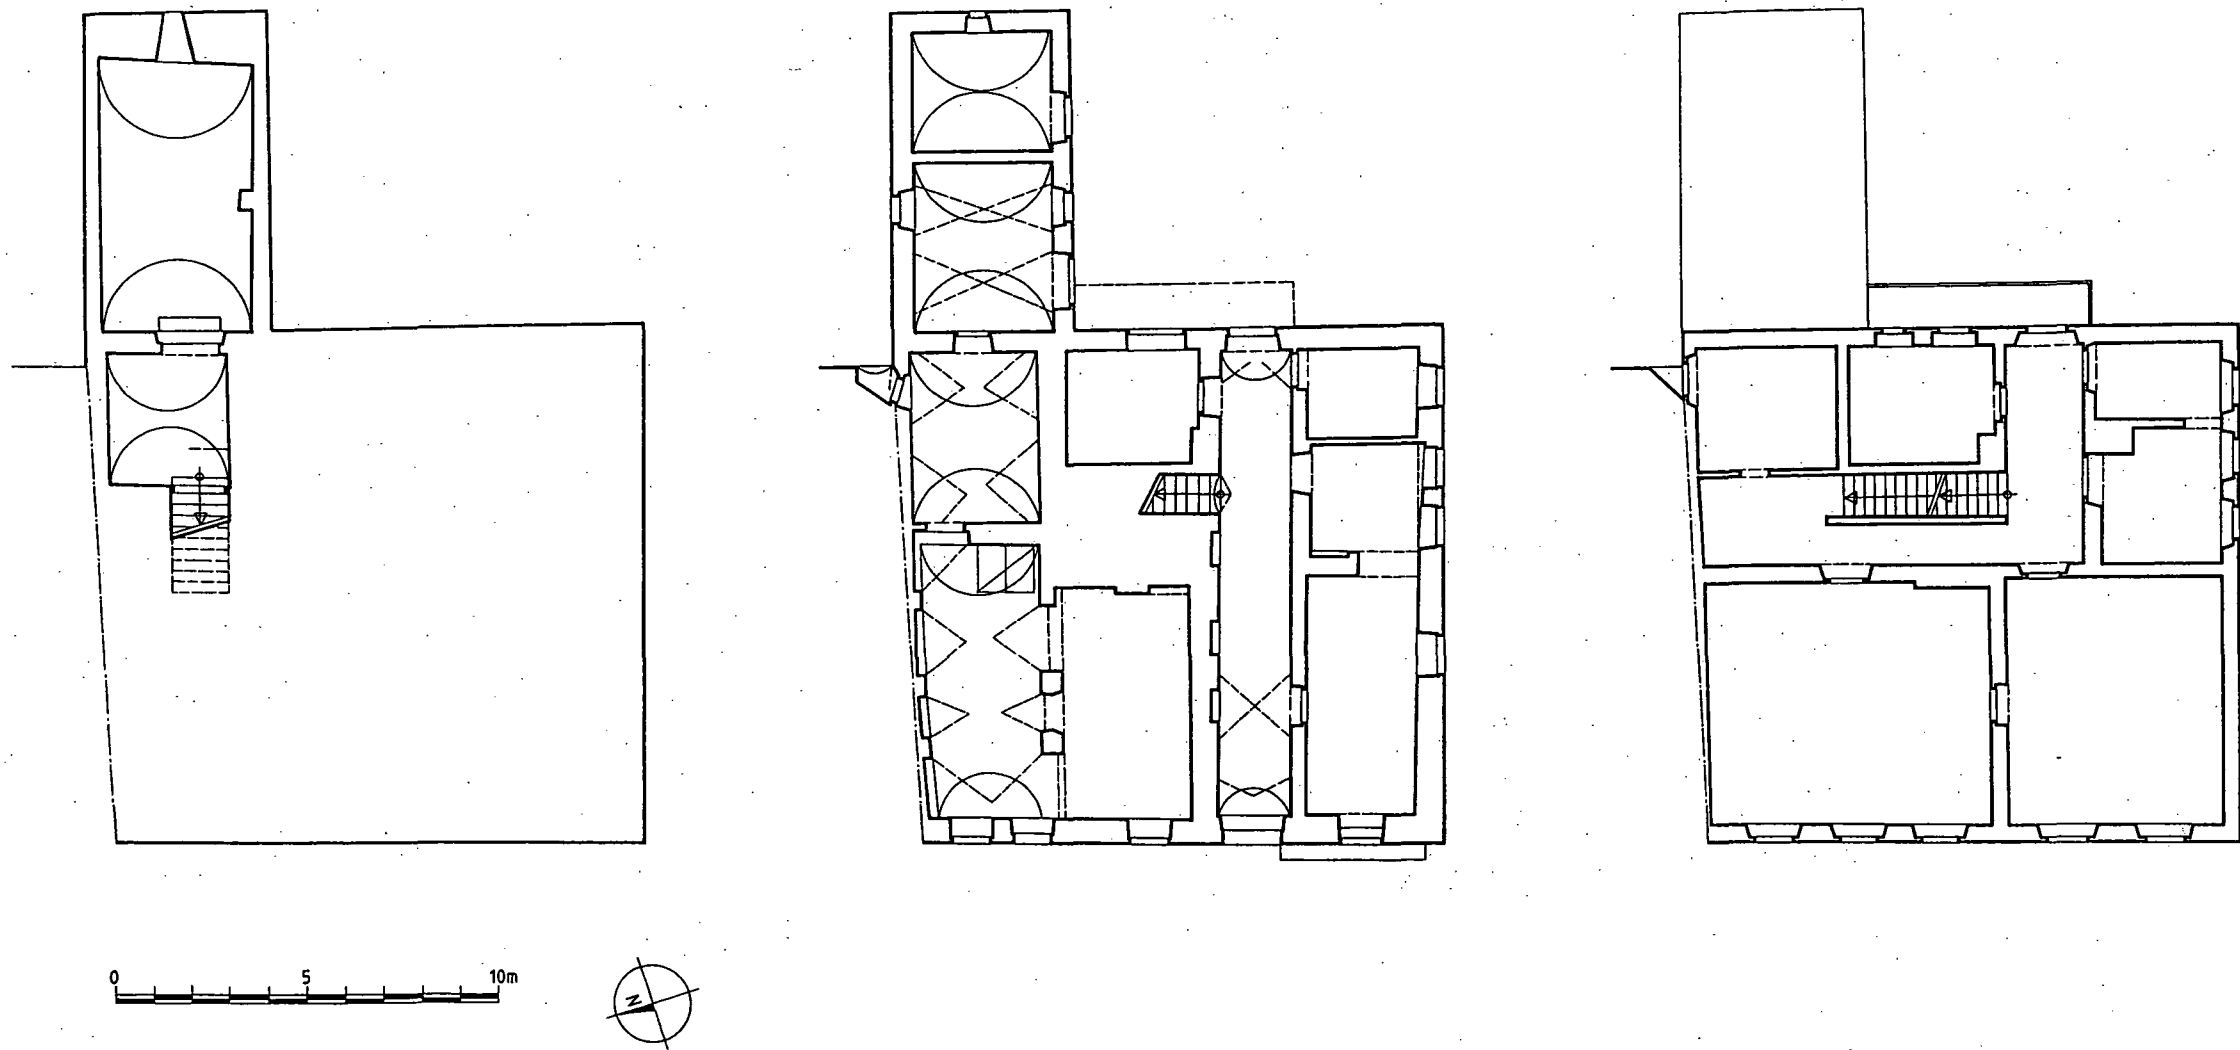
Starhembergstraße 6 – Grundrisse Keller, Erdgeschoss, Obergeschoss (1:200).
